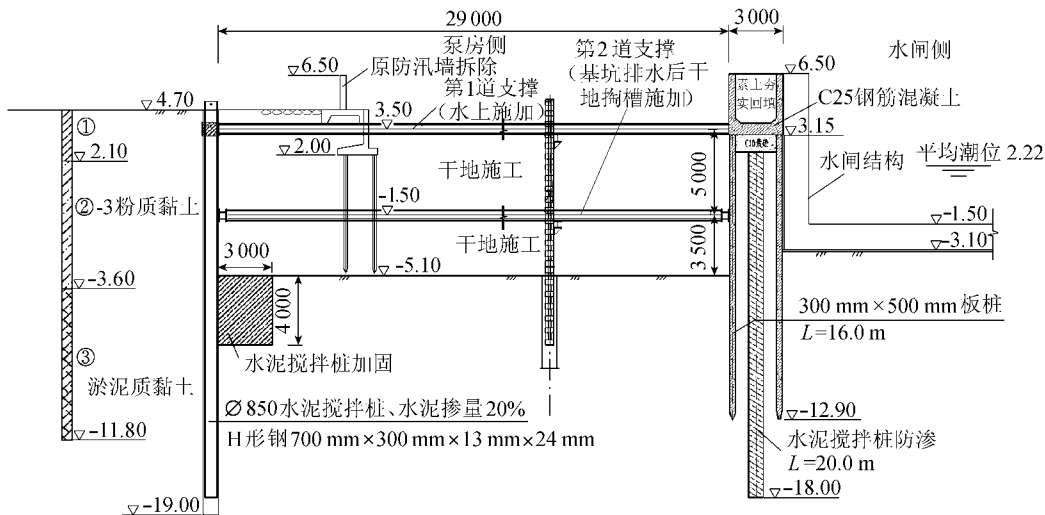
二期导流结构断面(高程单位:m,尺寸单位:mm)
